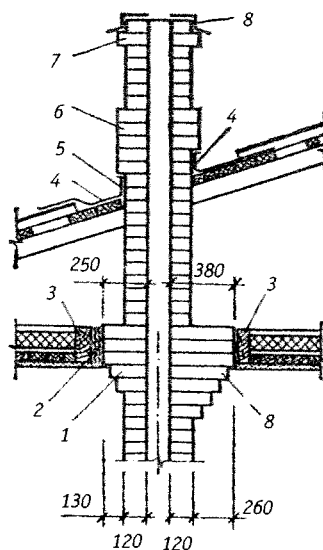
Противопожарные мероприятия при устройстве печного отопления — разделка печной трубы при проходе через сгораемые перекрытия:
